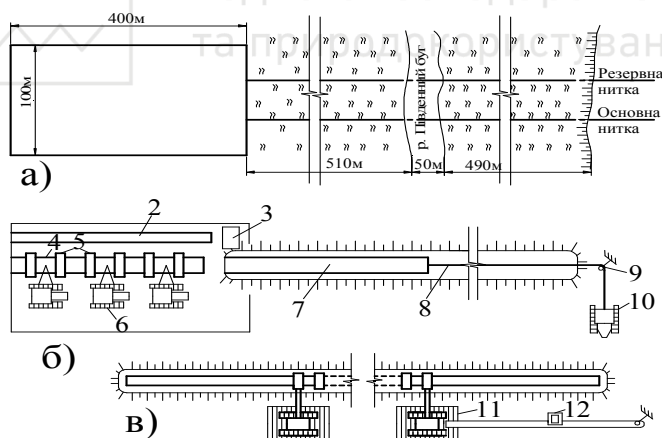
Схема укладання переходу трубопроводу через малу річку:
